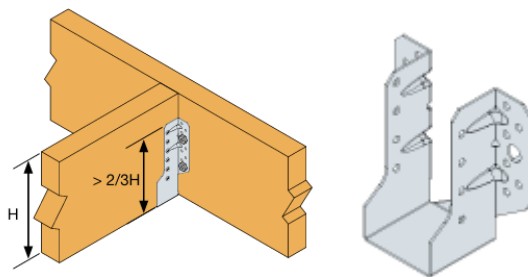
46: Fixation poutre-poutre et poutre-poteau [5]
